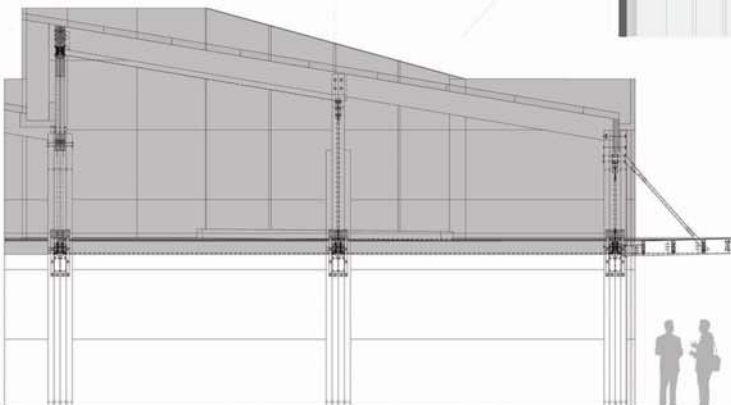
07 particolare costruttivo di un singolo box fronte ovest - pianta in alto e prospettosopral
